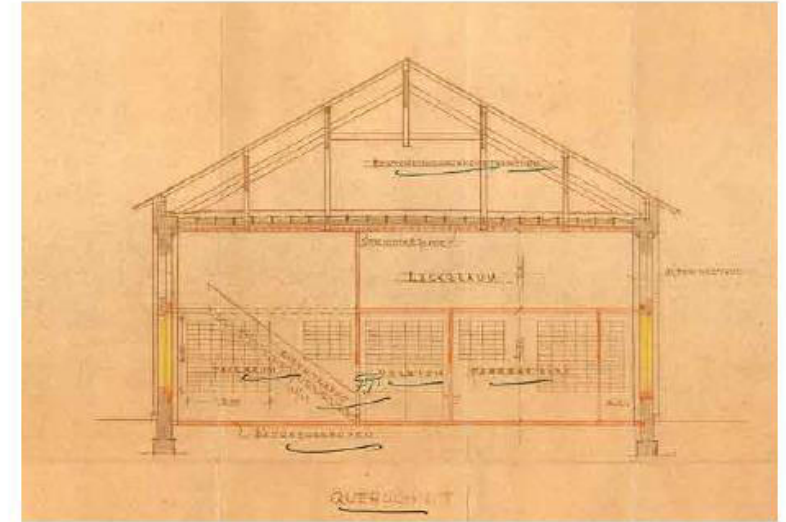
Plan für den Umbau als Fahrrad-/Automobil-Werkstatt (1927). Architekt: Walter Hämer. Querschnitt, Blick nach Westen. Fensteröffnungen in Außenwänden, Zwischendecke, Decke 1. OG verstärkt und verputzt, Treppe mit Eisengeländer (Bd. 05/018)
